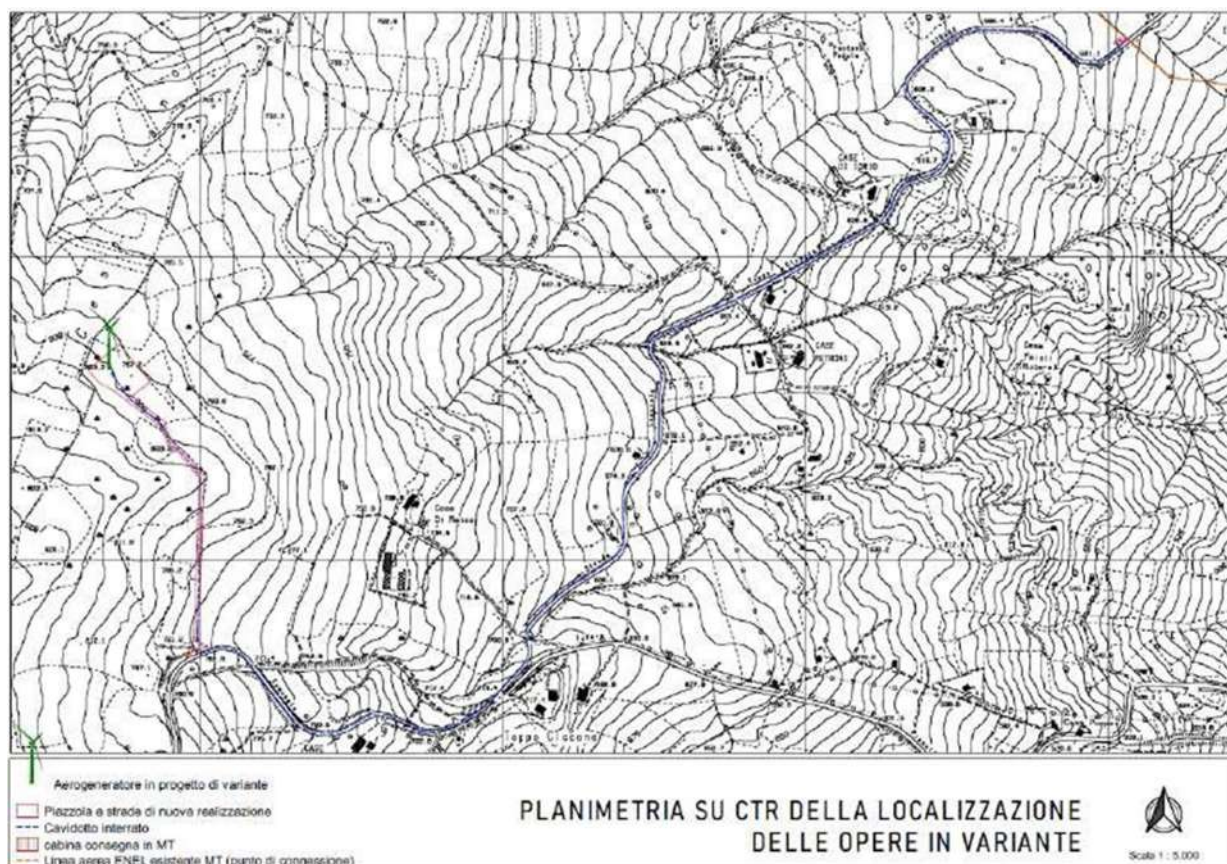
Planimetria della ubicazione delle opere in variante di progetto su CTR.
